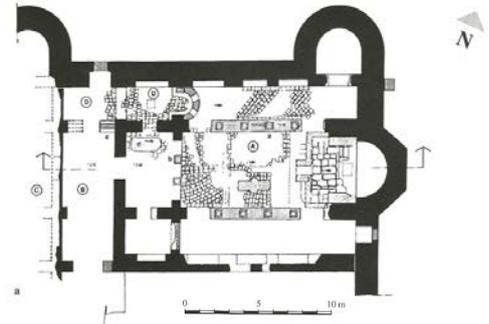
Die Kirche in Bregovina, Grundriss
